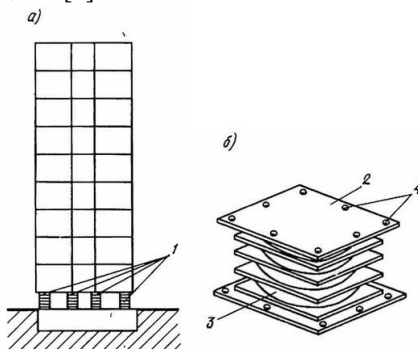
Сейсмоизоляция здания с помощью резинометаллических опор: *a* – схема установки опоры; *б* – схема конструкции опоры GAPEC; 1 – опора; 2 – стальная плита; 3 – слой неопрена; 4 – отверстия для анкерных болтов
